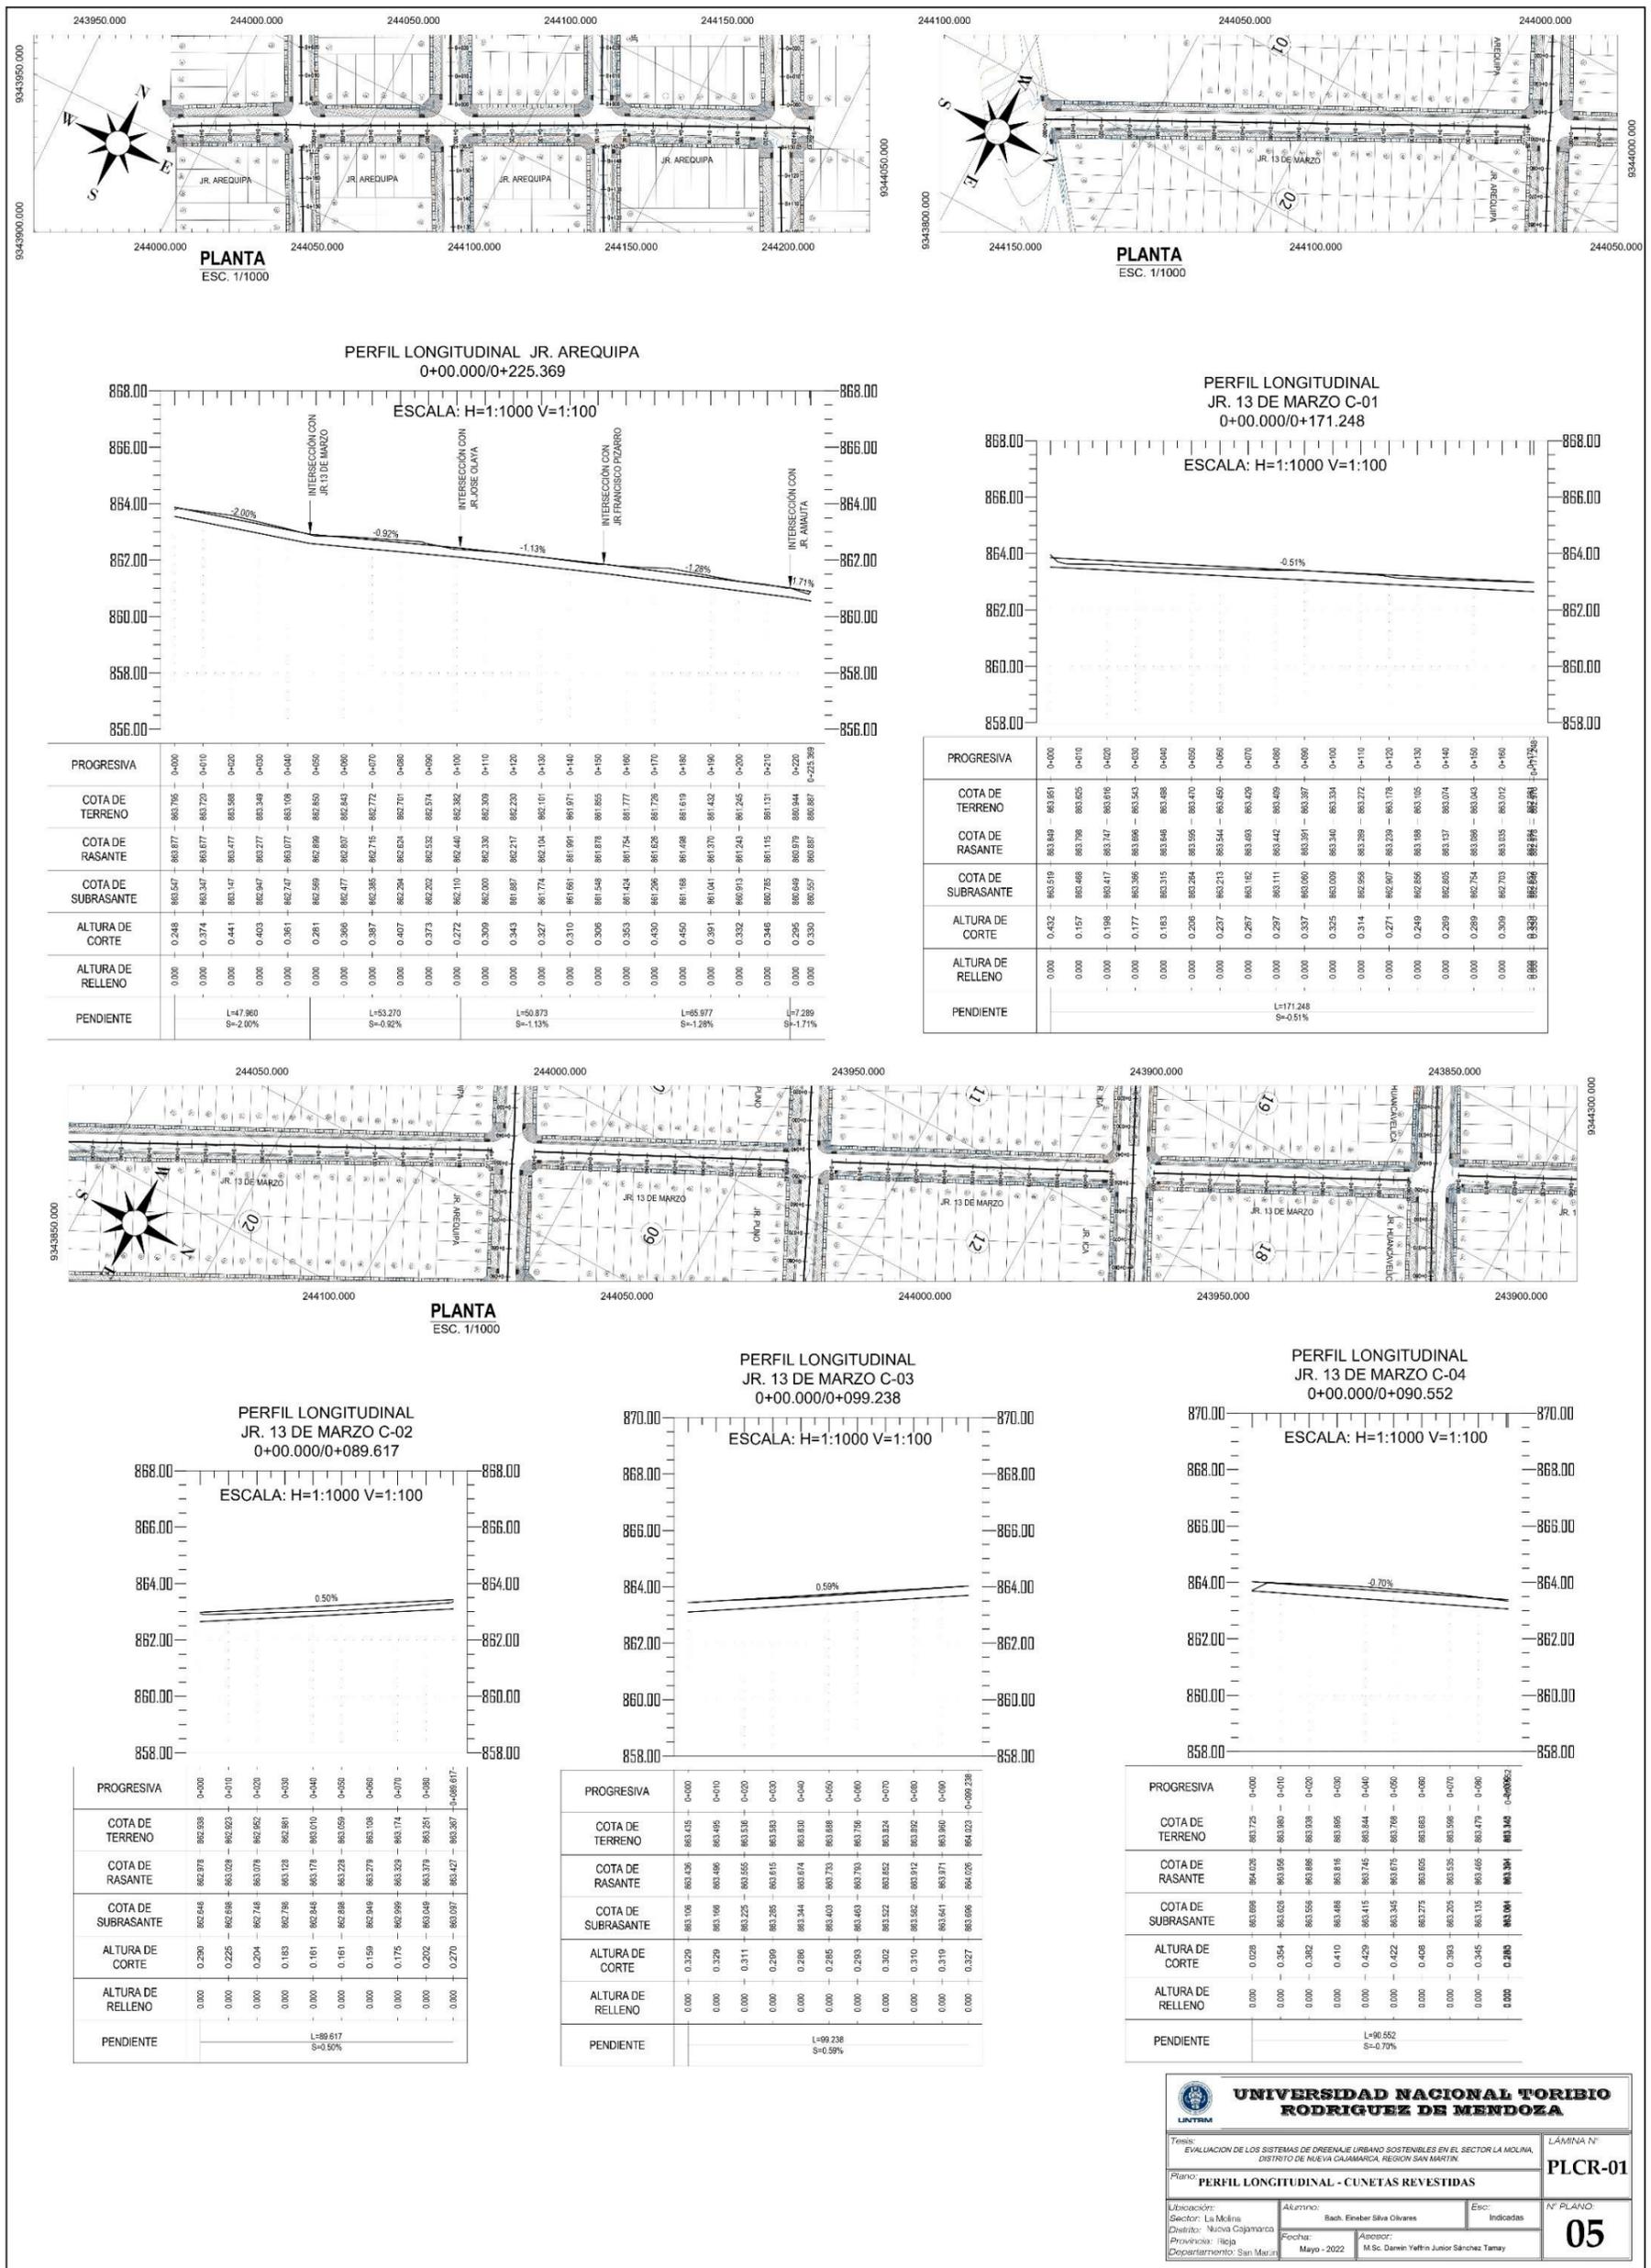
Planteamiento general con drenaje convencional - cunetas revestidas de concreto.
